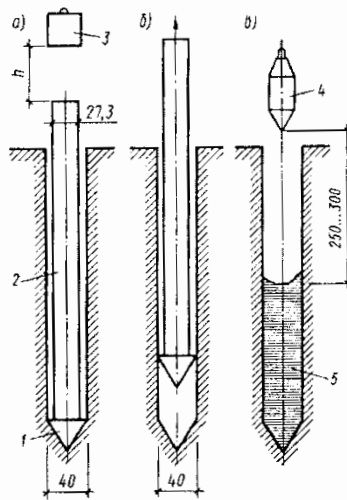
Схема устройства грунтовых свай способом сердечника:
